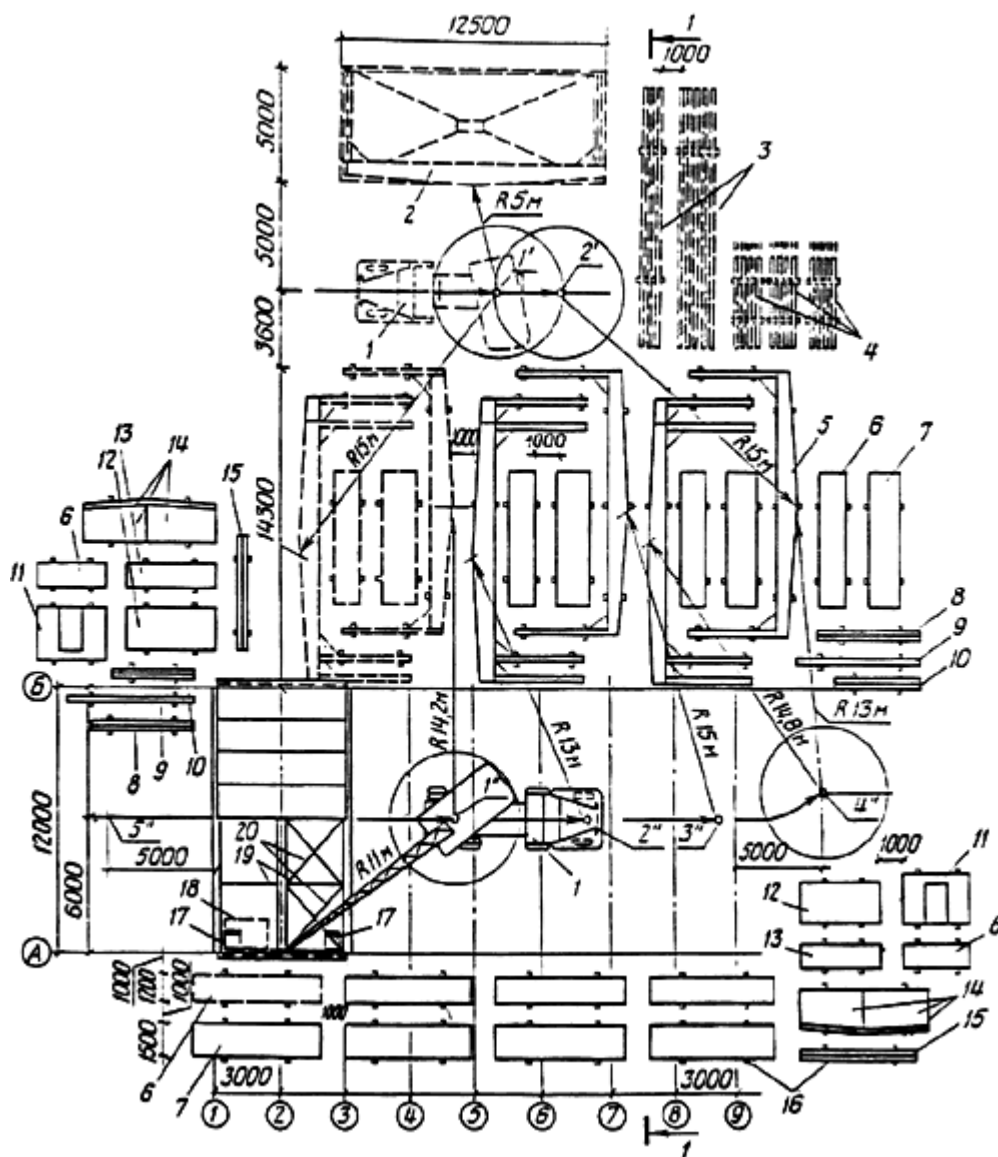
Схема организации строительной площадки при укрупнении рам и монтаже каркаса (вариант Д):
